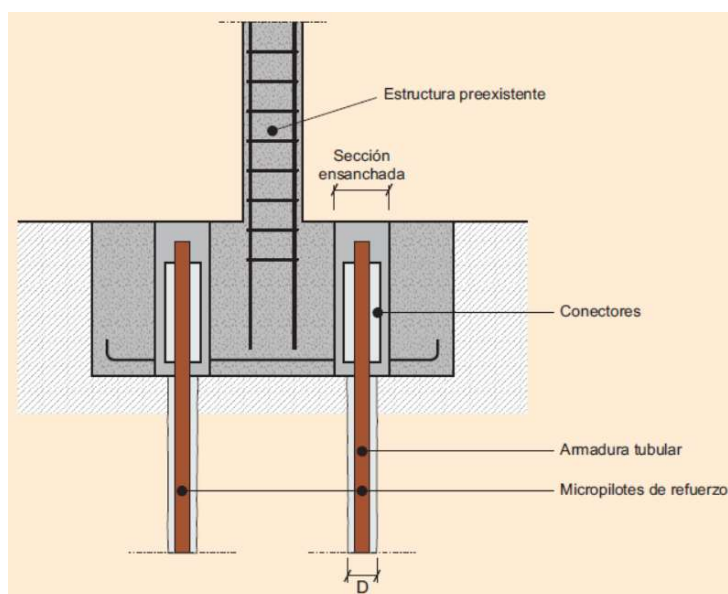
Ejemplo de conexión directa a una cimentación preexistente de hormigón armado, con sección de perforación ensanchada. Fuente: Guía para el proyecto y ejecución de micropilotes en obras de carretera
